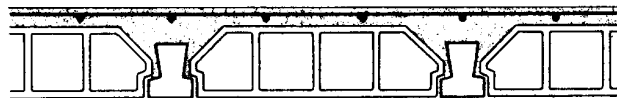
Forjados de semiviguetas con bovedillas y relleno de senos.
